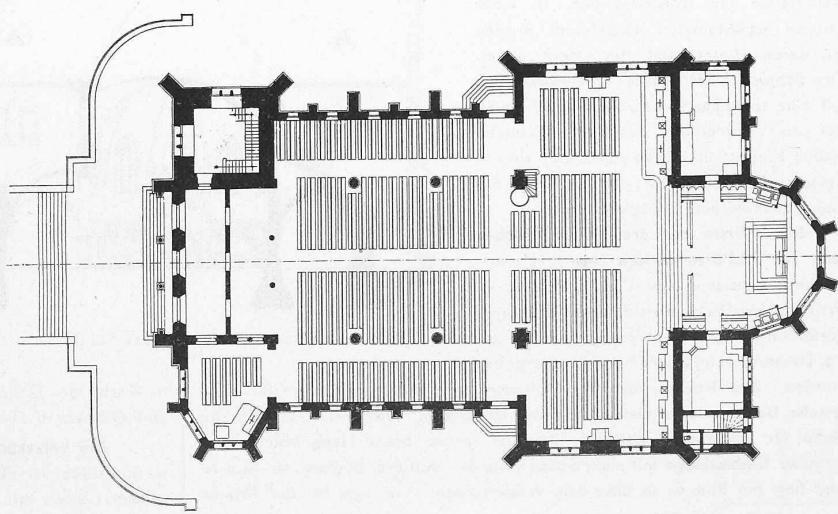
Grundriss der St. Michaelskirche in Zug. — Masstab 1:600.
